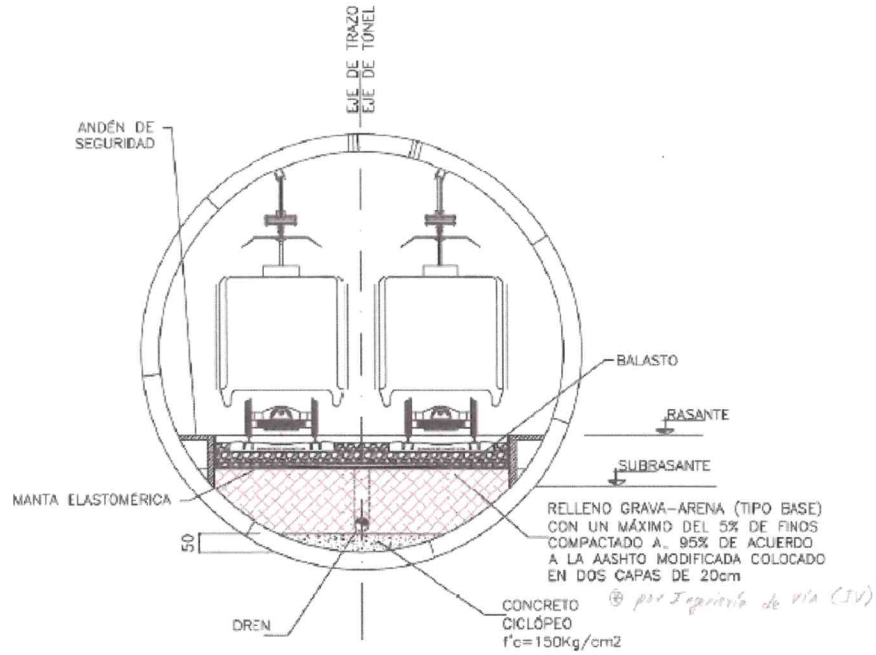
Sección transversal del sistema de drenaje con las coladeras de piso (pk 24+680 al pk 25+313)
